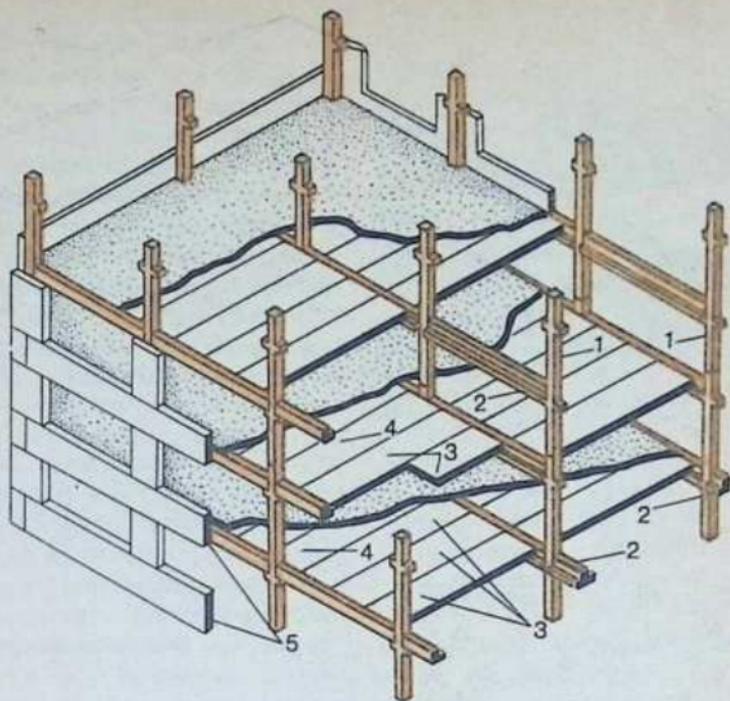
Конструктивная схема каркасного здания с продольными ригелями:
